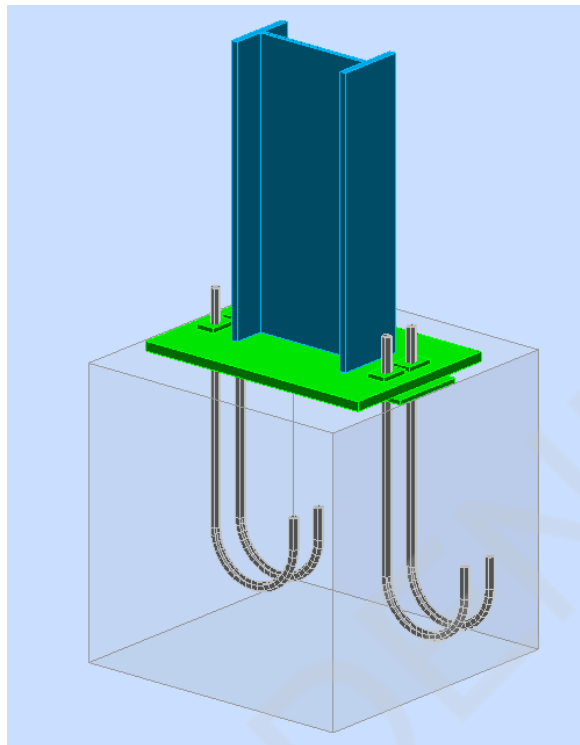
Vue d'assemblage pied du poteau encastré
